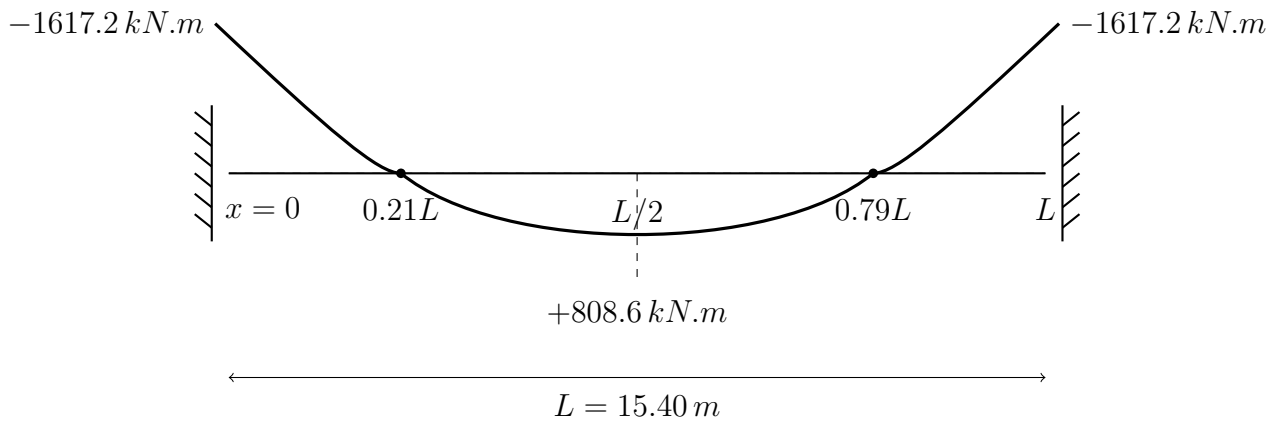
Diagramme du moment fléchissant de la poutre principale bi-encastree
